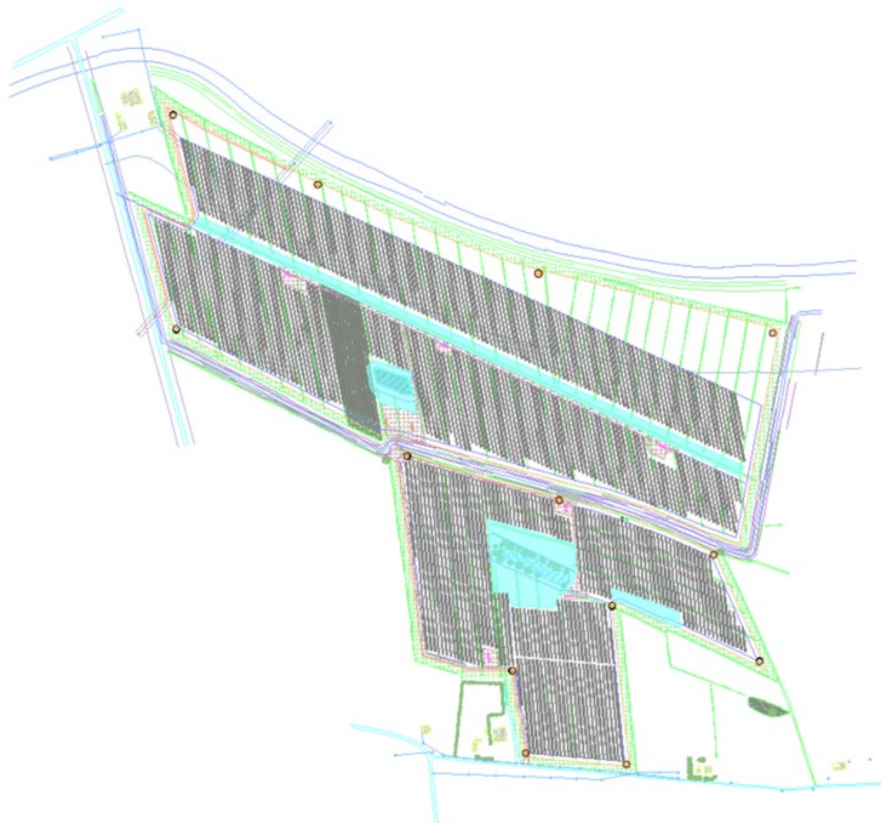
Layout campo Sud dell'impianto fotovoltaico
